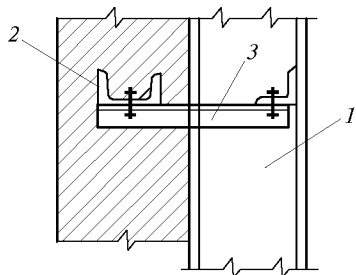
Крепление ветрового ригеля кирпичной стены к колонне
